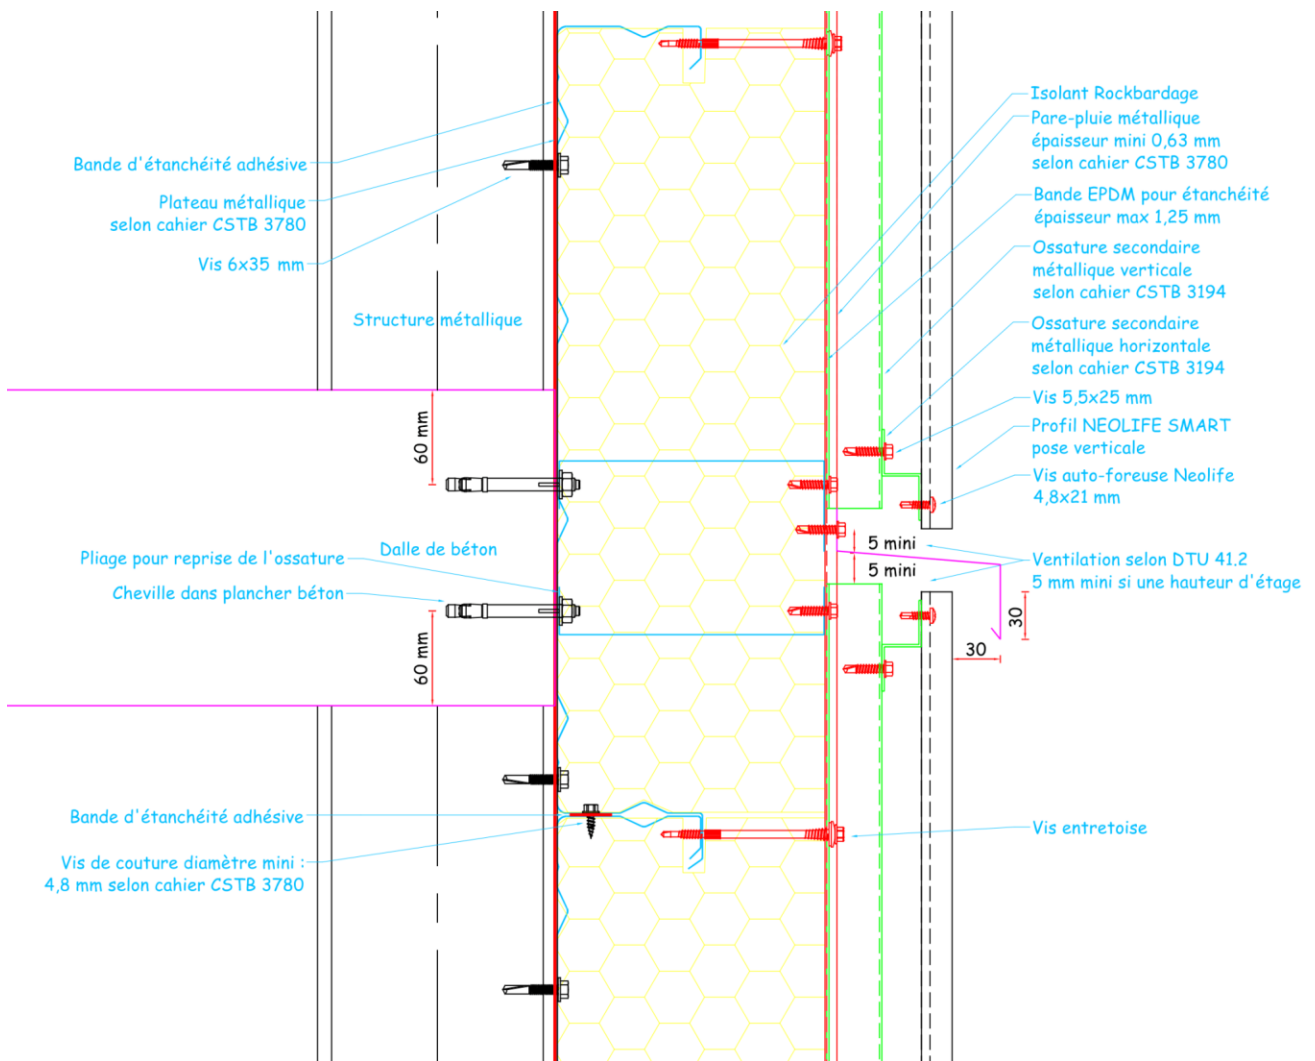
Fractionnement au droit de chaque plancher en zone sismique (coupe verticale)
